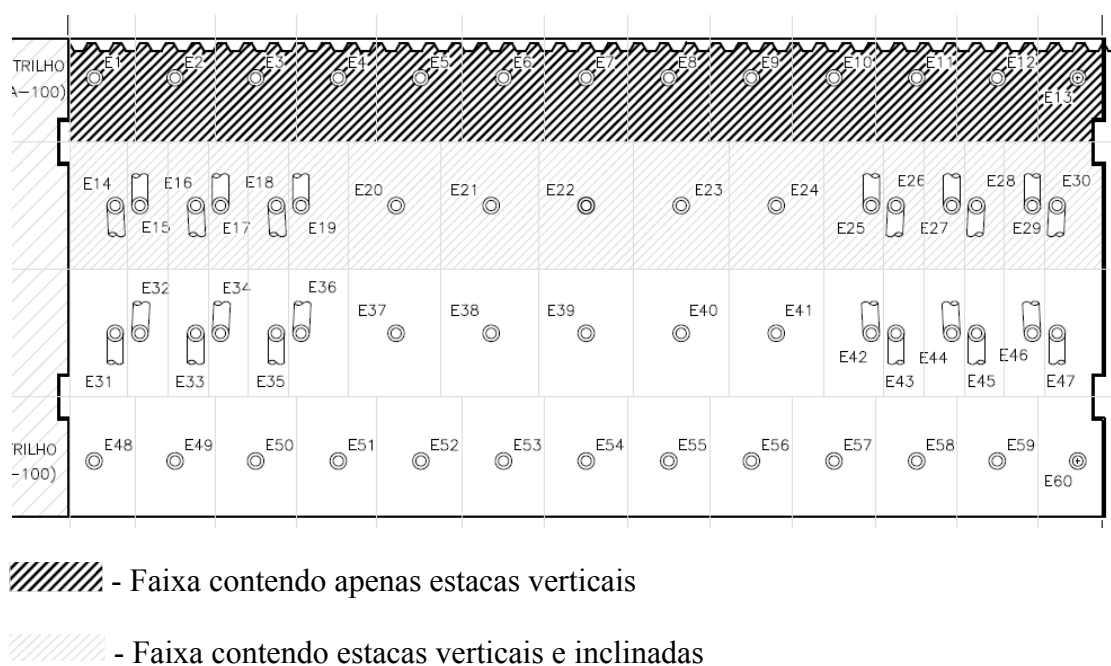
Planta baixa demarcando as faixas de áreas de influência utilizadas para construção dos pórticos no software Ftool
